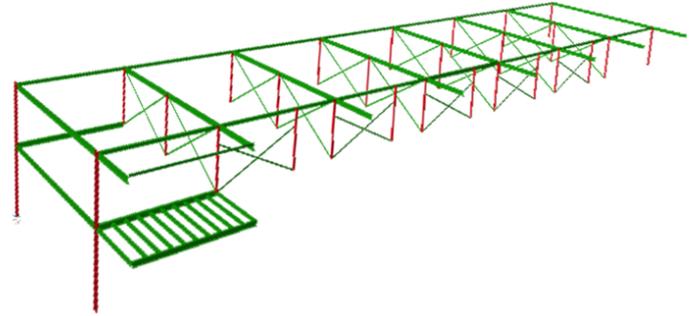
IMAGEN DEL MODELADO DE LA ESTRUCTURA DE LAS AULAS
